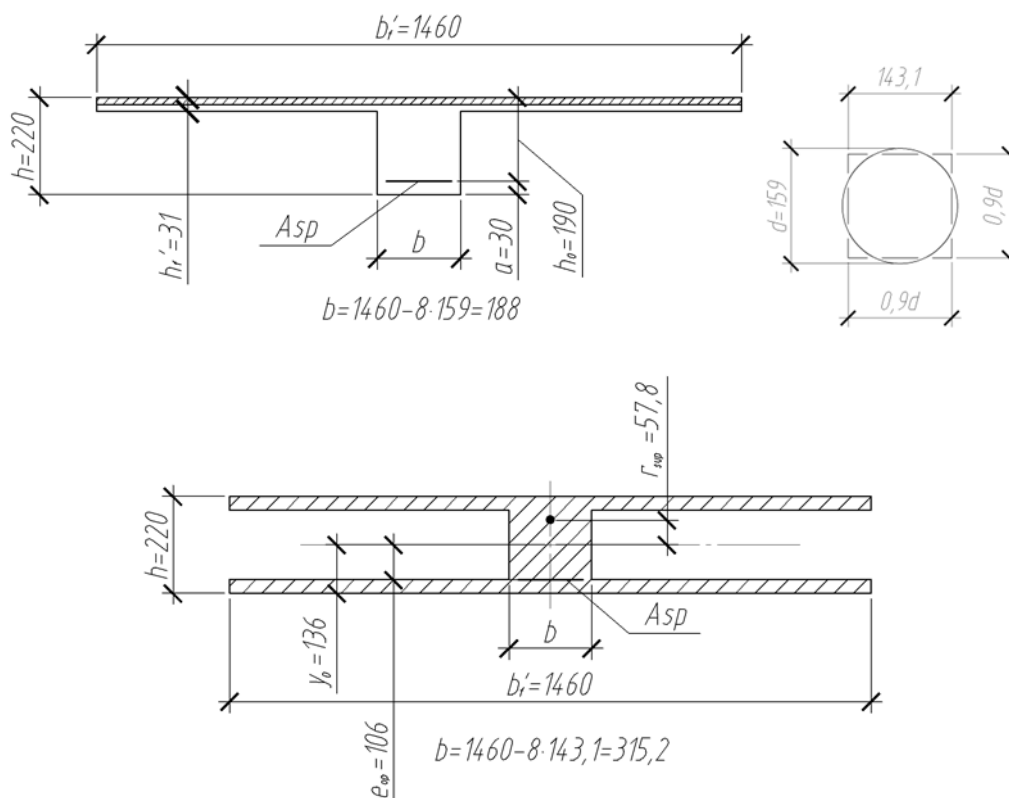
Поперечные сечения плиты с круглыми пустотами
